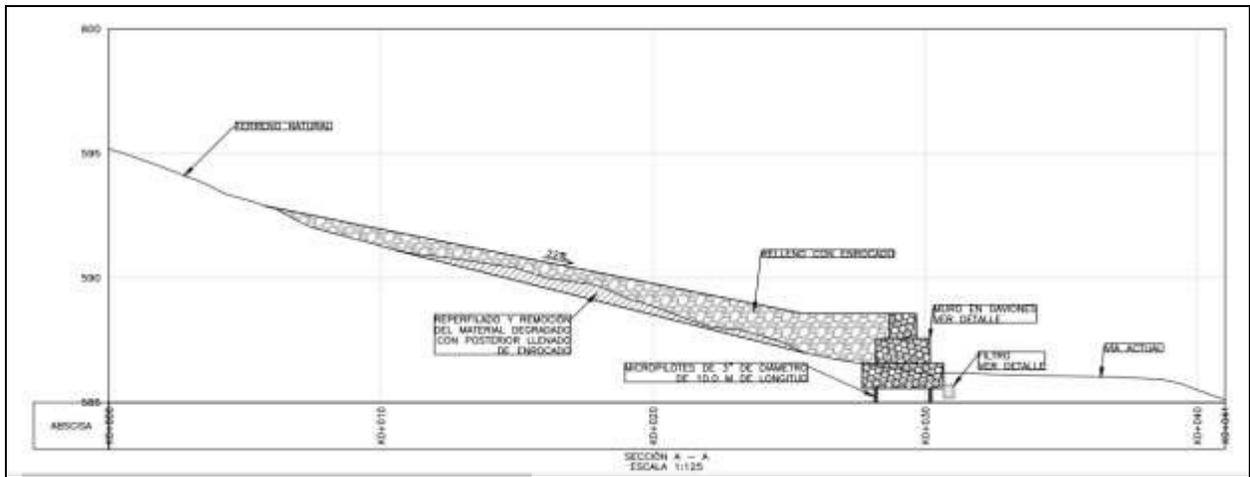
Detalle corte vista en perfil muro gavión Km 29 + 200
